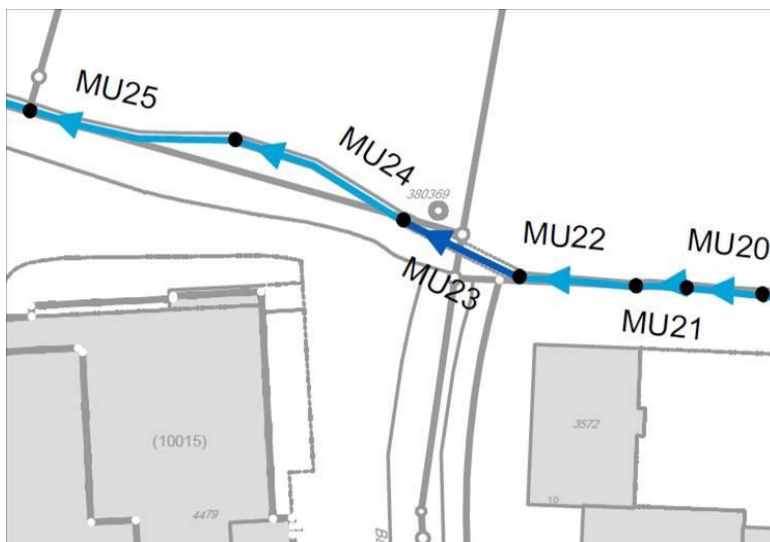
; Ausschnitt aus Plan Haltungen GEP (Genereller Entwässerungsplan) Berechnung (ohne Masstab)
